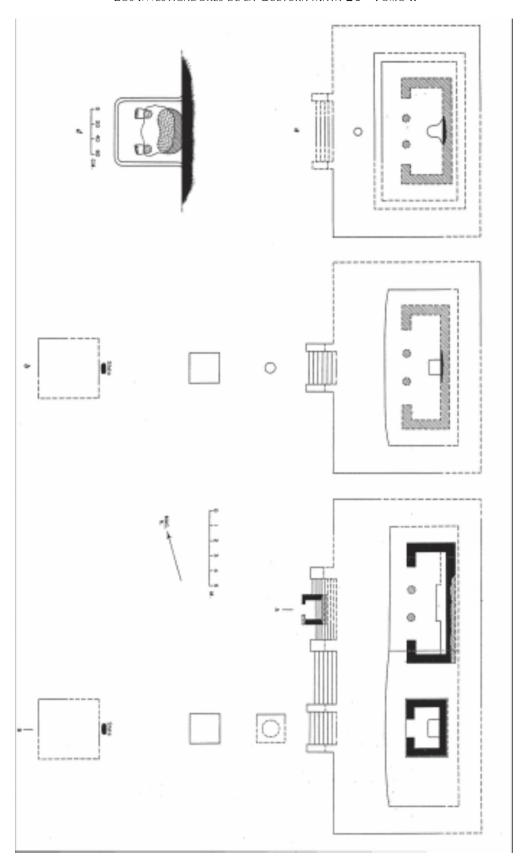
UBICACIÓN DEL GRUPO DEL CENOTE XCOTÓN; PLANTA Y CORTES DEL CENOTE Y PLANTAS DE LAS ESTRUCTURAS T.70 Y T.72 (MORRIS 1962; SMITH 1953:44, FIG. 5.1).
